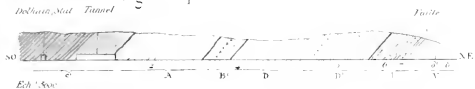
Coupe entre la Station de Trooz-Aval et Basse-Fraipont
